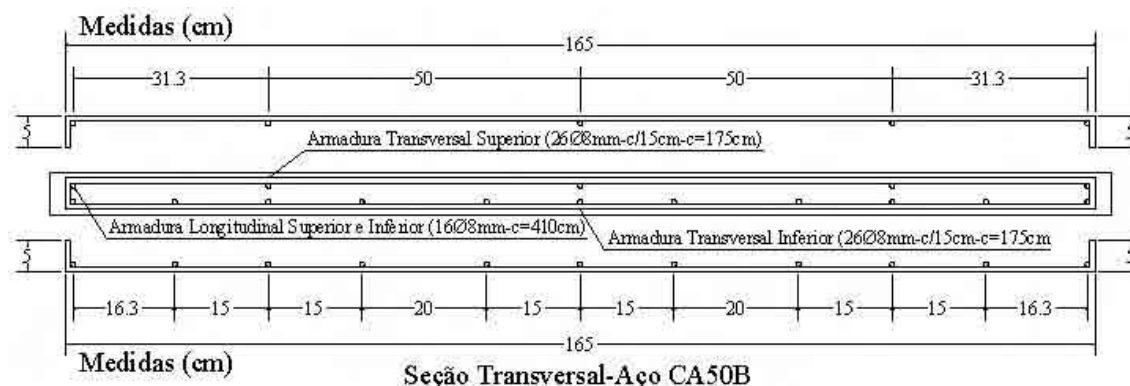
Detalhamento da armadura da laje de concreto do tabuleiro misto de madeira-concreto
